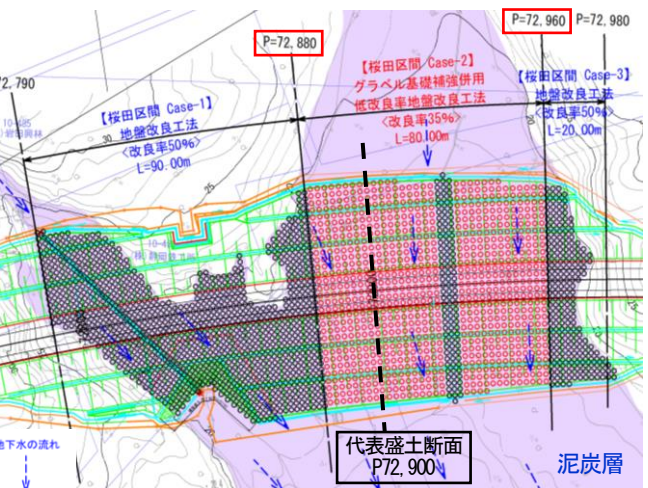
当該盛土区間の対策工平面図 (P72,790~72,980)
